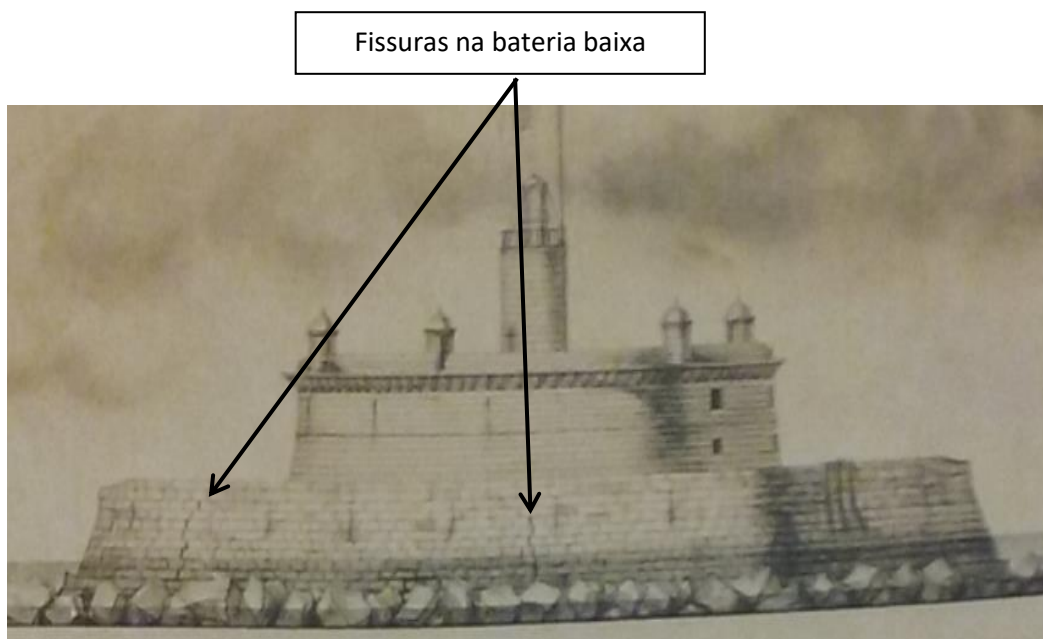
Representação em alçado das fissuras presentes na bateria baixa do Forte do Bugio, 1788, adaptado de (Boiça & Barros, 2004)
